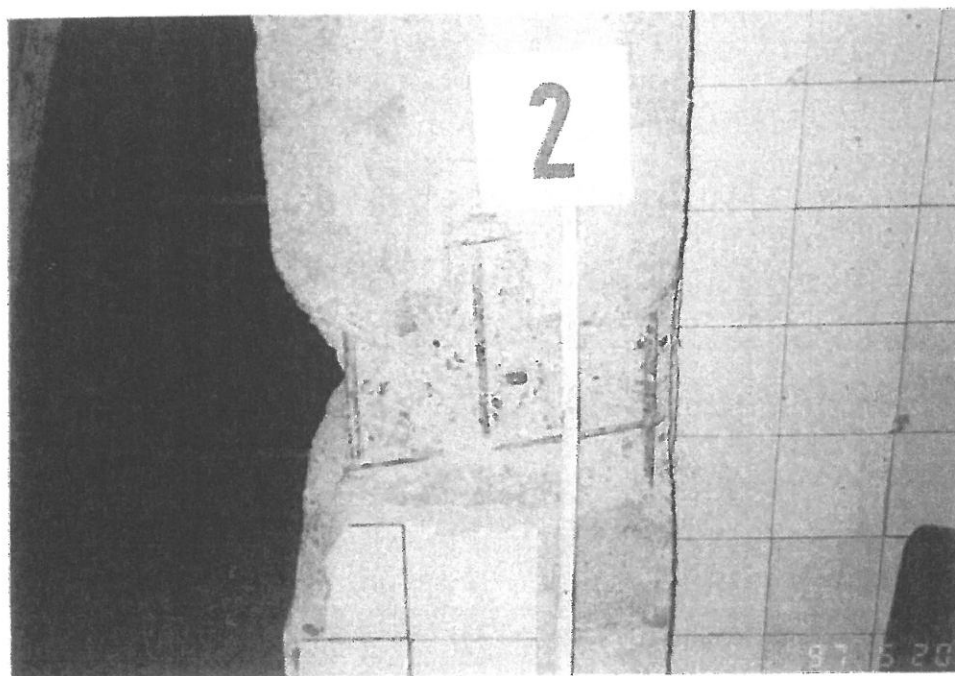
1. NP – žebet. sloup 410 x 440 mm je
